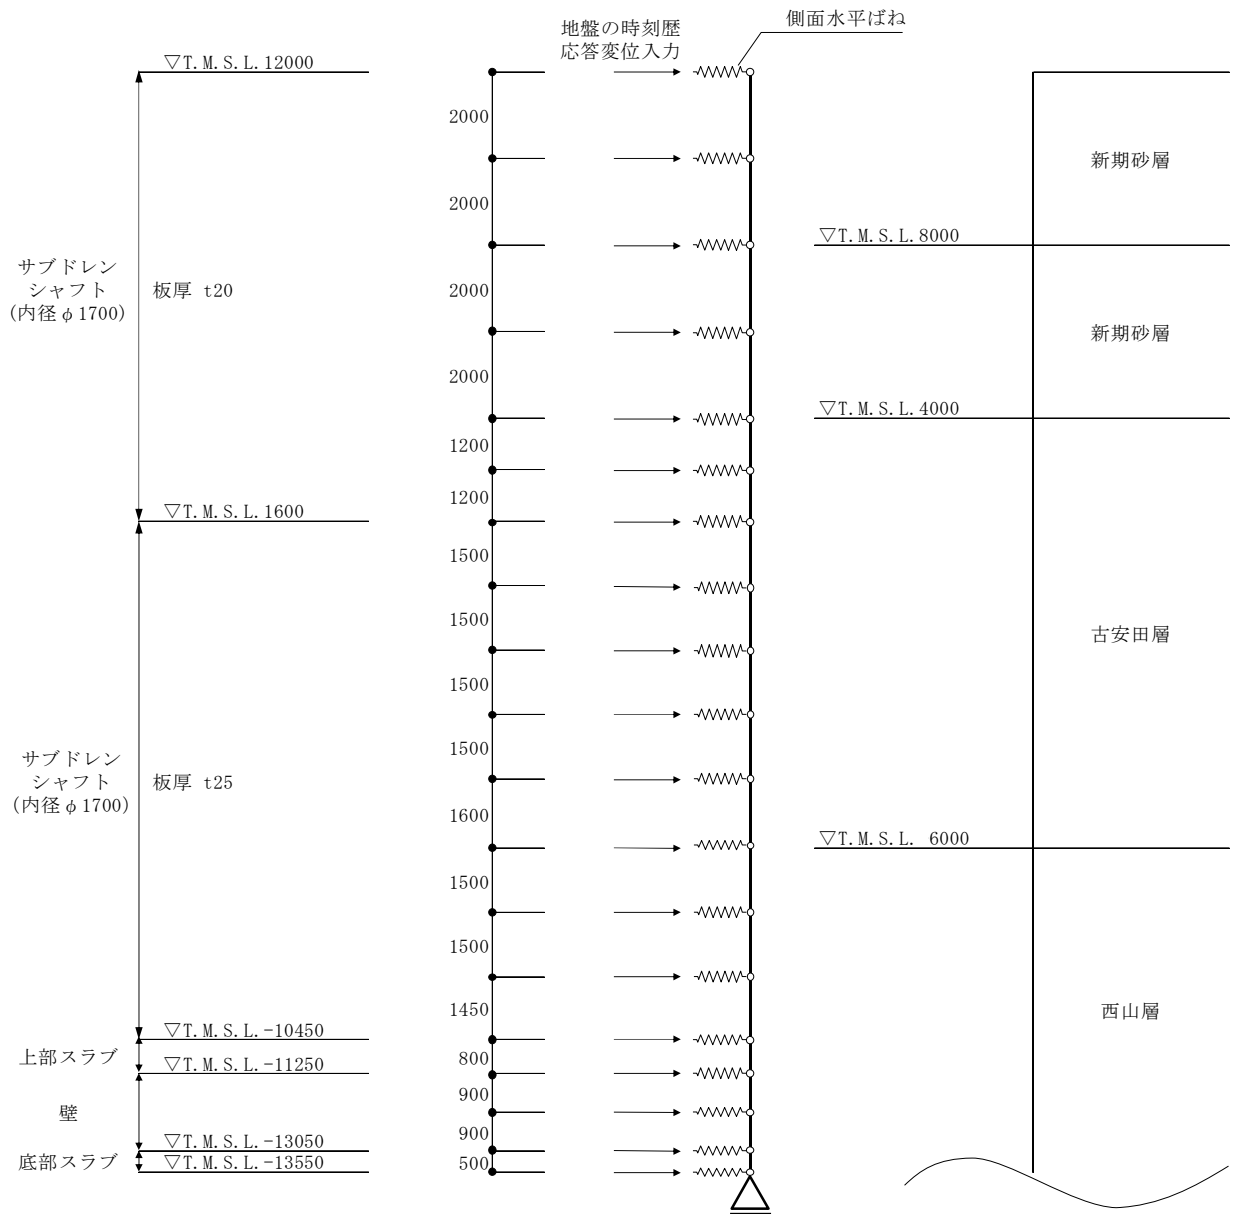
管軸方向断面の応力解析モデル (タービン建屋) (単位: mm)
